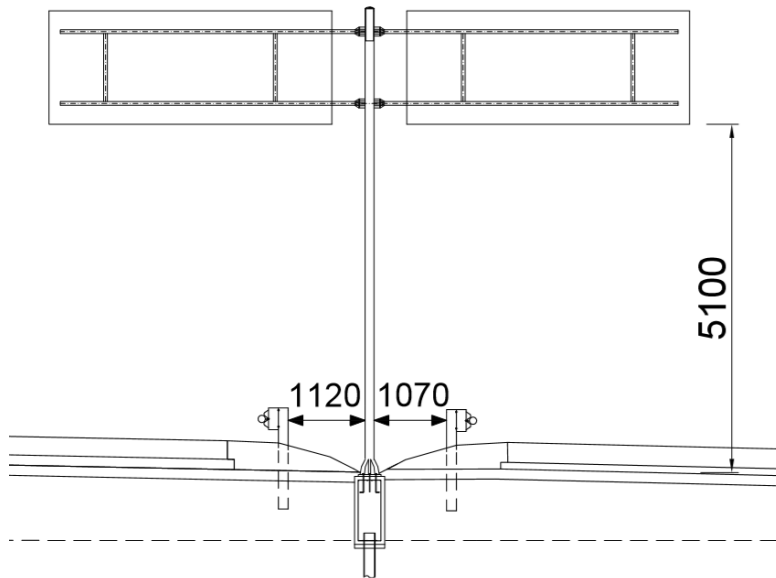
Rambu Petunjuk Peringatan dan Larangan Tipe A
